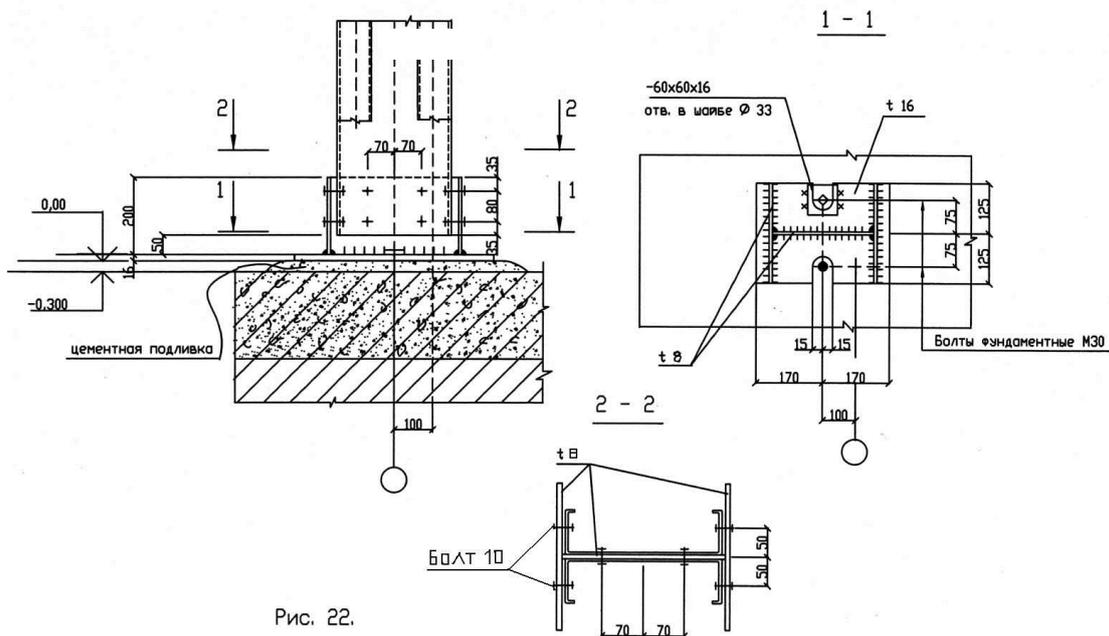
Узел опирания стоек рам каркаса на железобетонный фундамент
